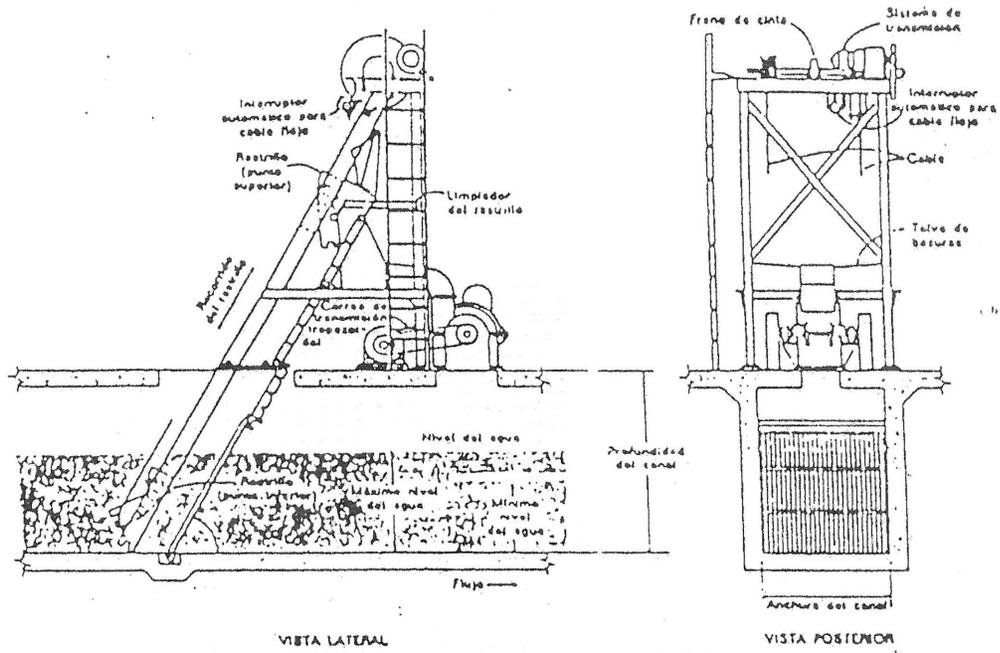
REJILLA MECÁNICA DE LIMPIEZA FRONTAL
